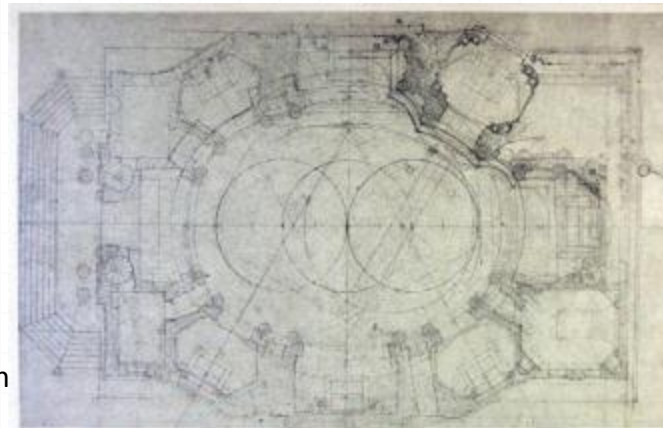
e 37: planta baixa e fachada de San Carlo alle Quattro Fontane, 1665-67, Roma.
